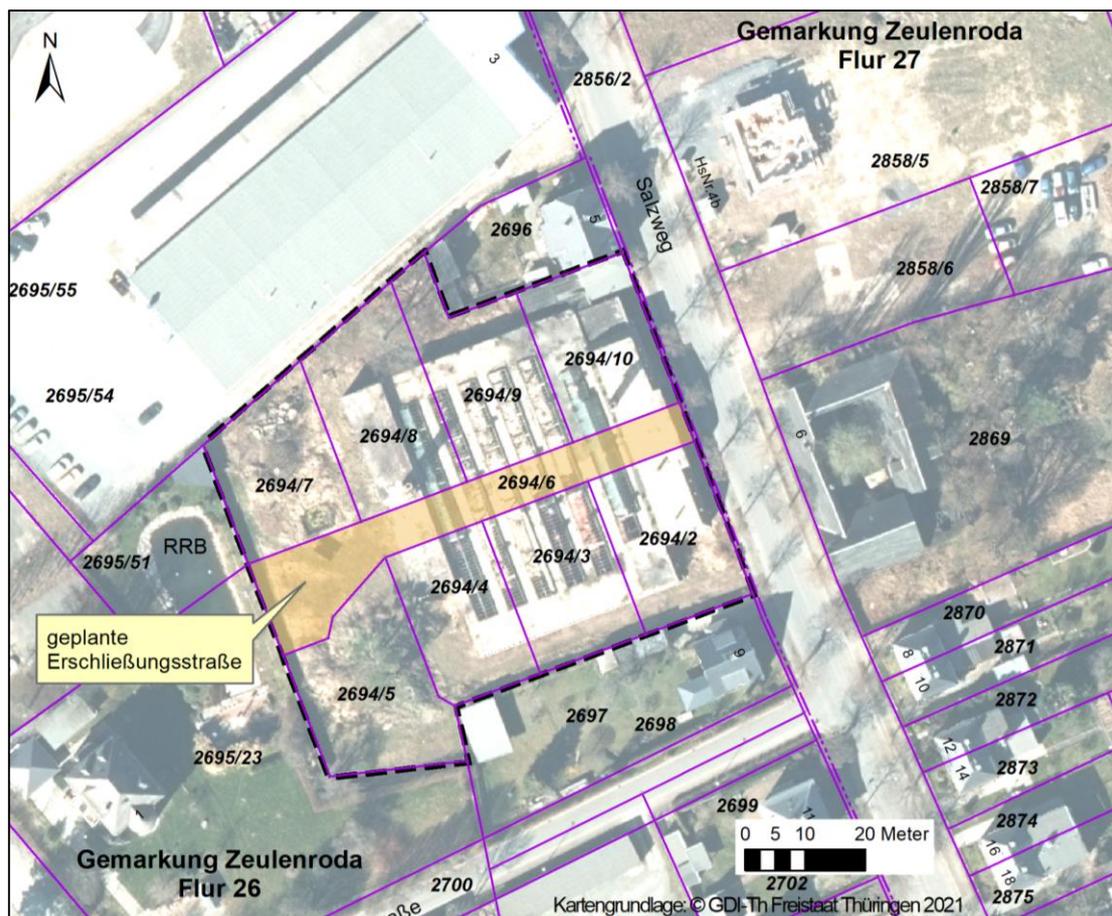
Lageplan des Straßenbauvorhabens (orange)
